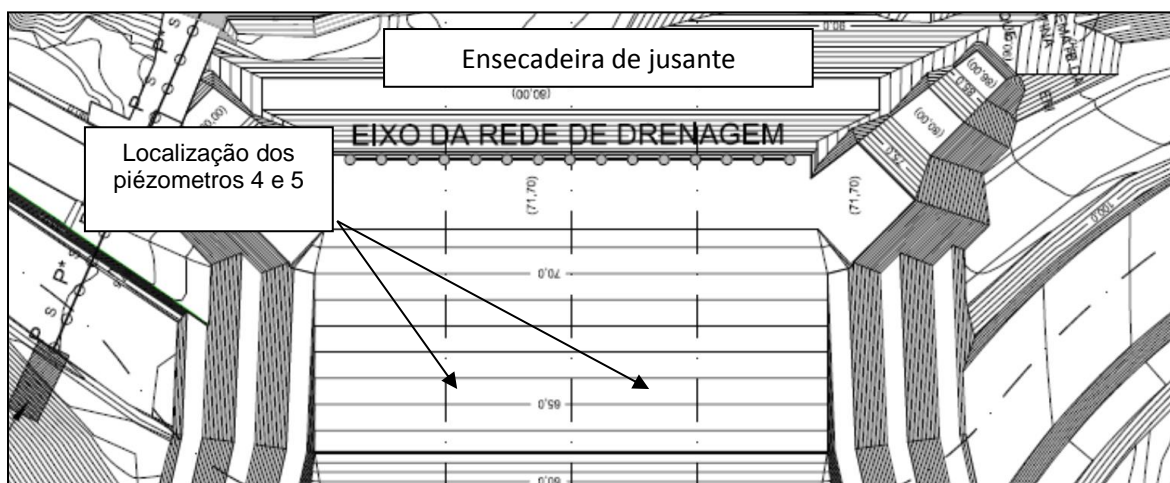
Planta com a rede de drenos prevista em projeto de execução (extrato da planta de escavações. COBA, 2008)
